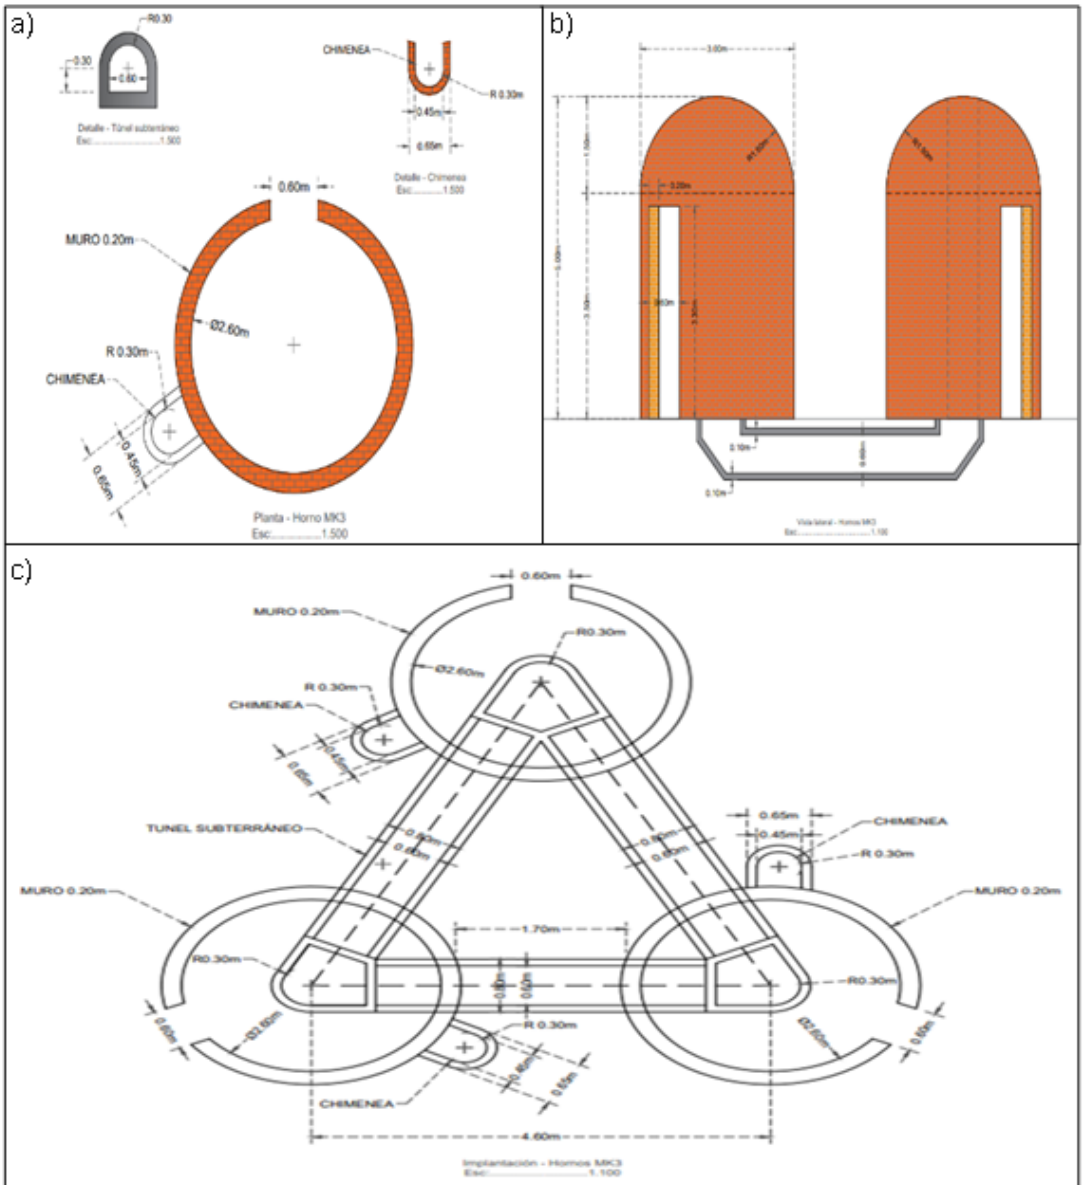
Prototipo del horno MK3: a) detalles planta, túnel y chimenea, b) vista lateral, c) plano general de las tres cámaras.
